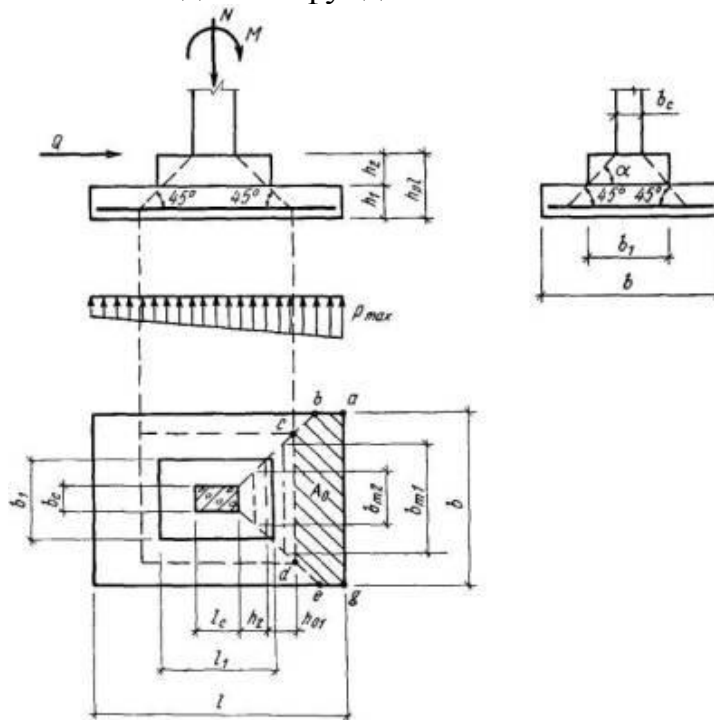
Схема образования пирамиды продавливания в центрально-нагруженных прямоугольных, а также внецентренно нагруженных квадратных и прямоугольных фундаментах
